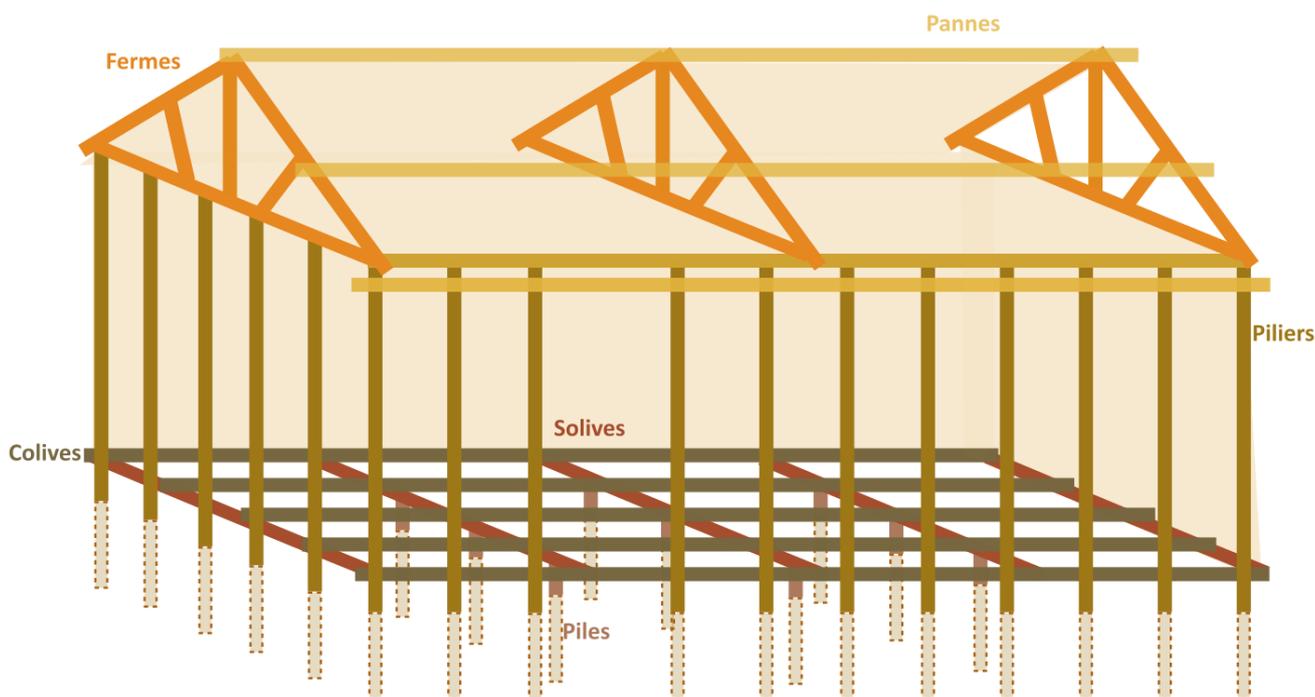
Plan simplifié d'une maison de 3x5 m traditionnelle (Inter Aide)
